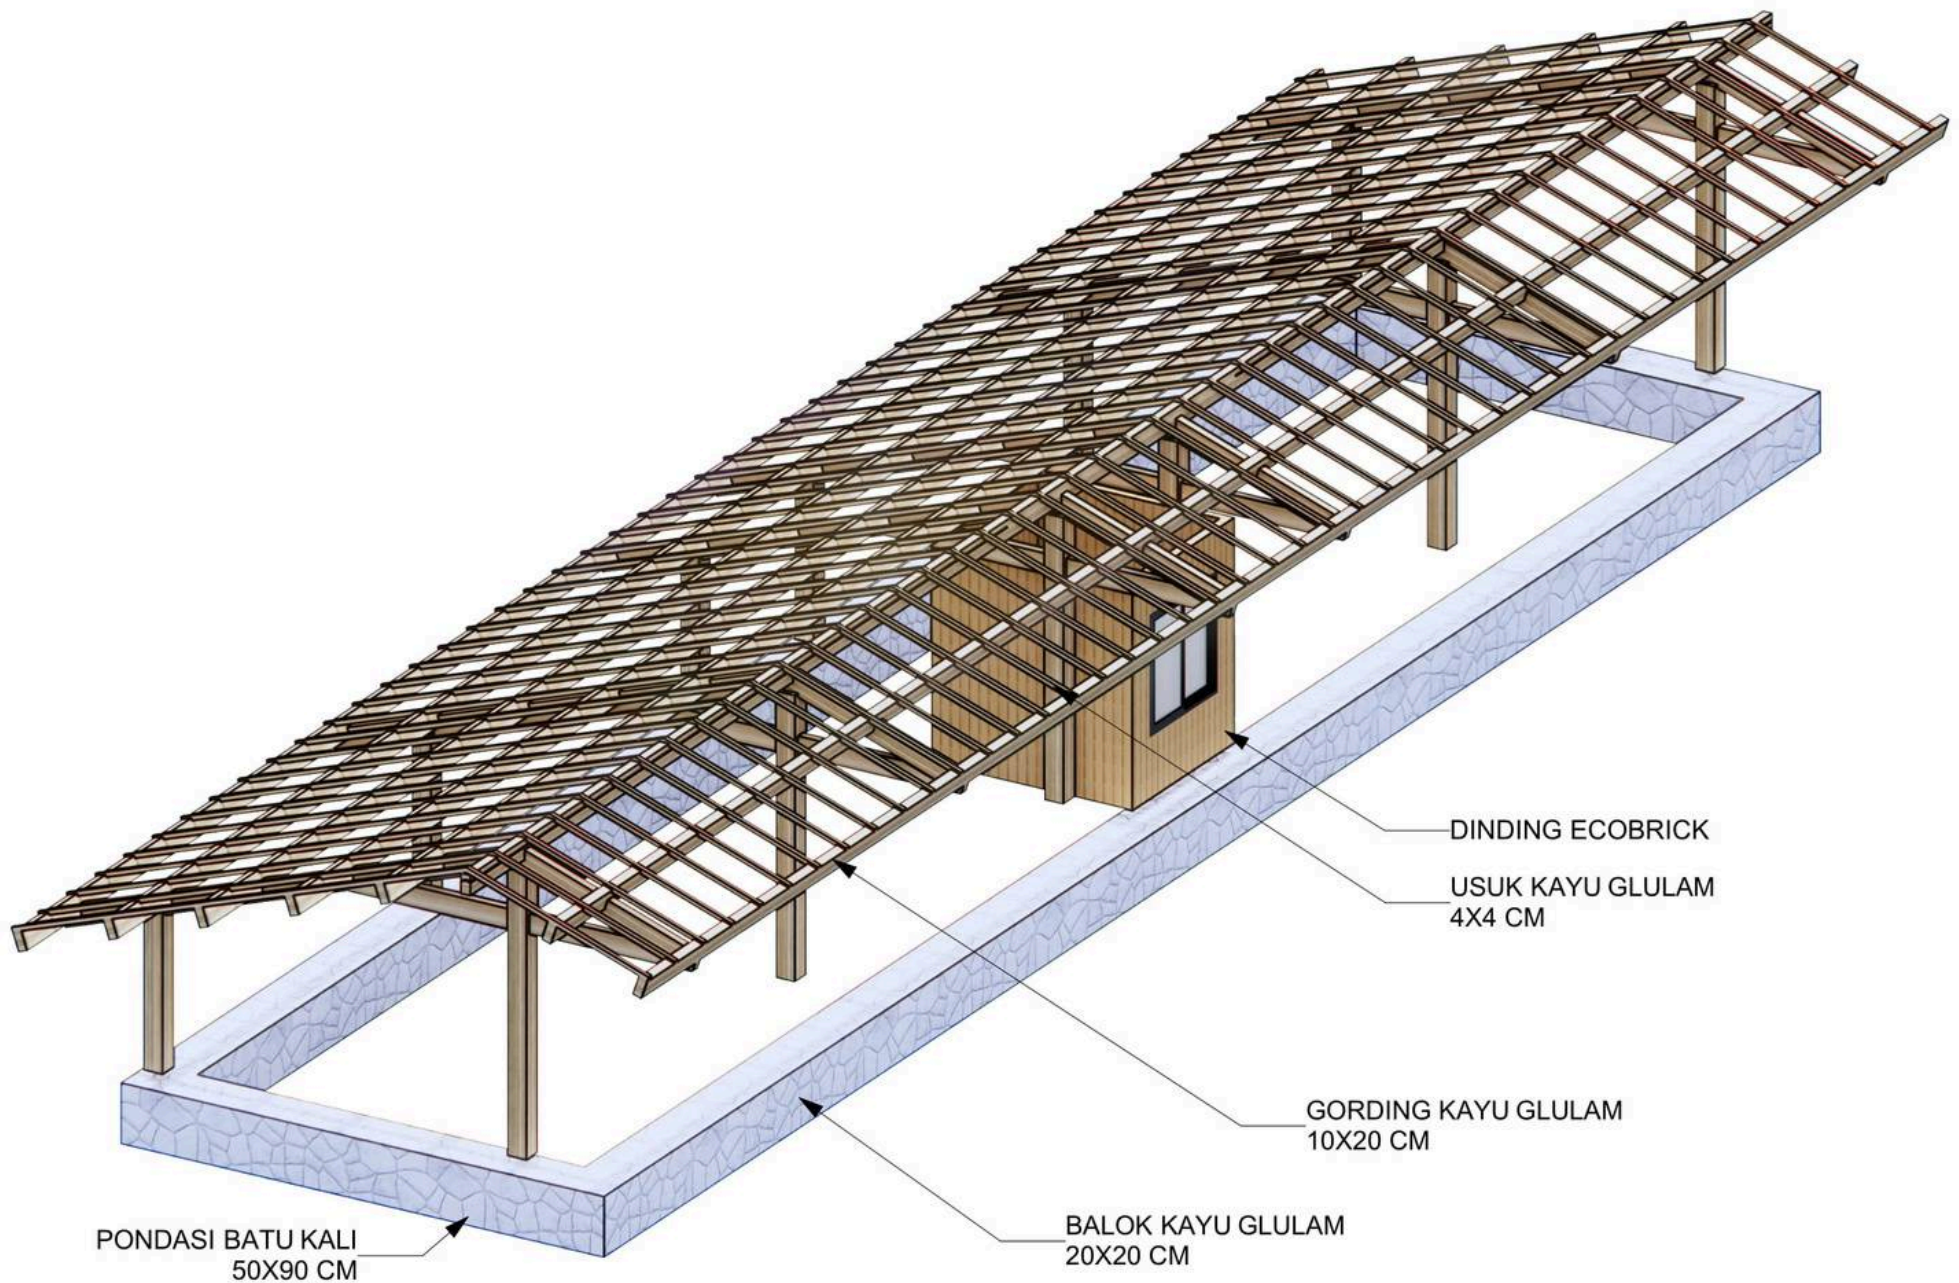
Struktur bentuk bangunan tipe B
